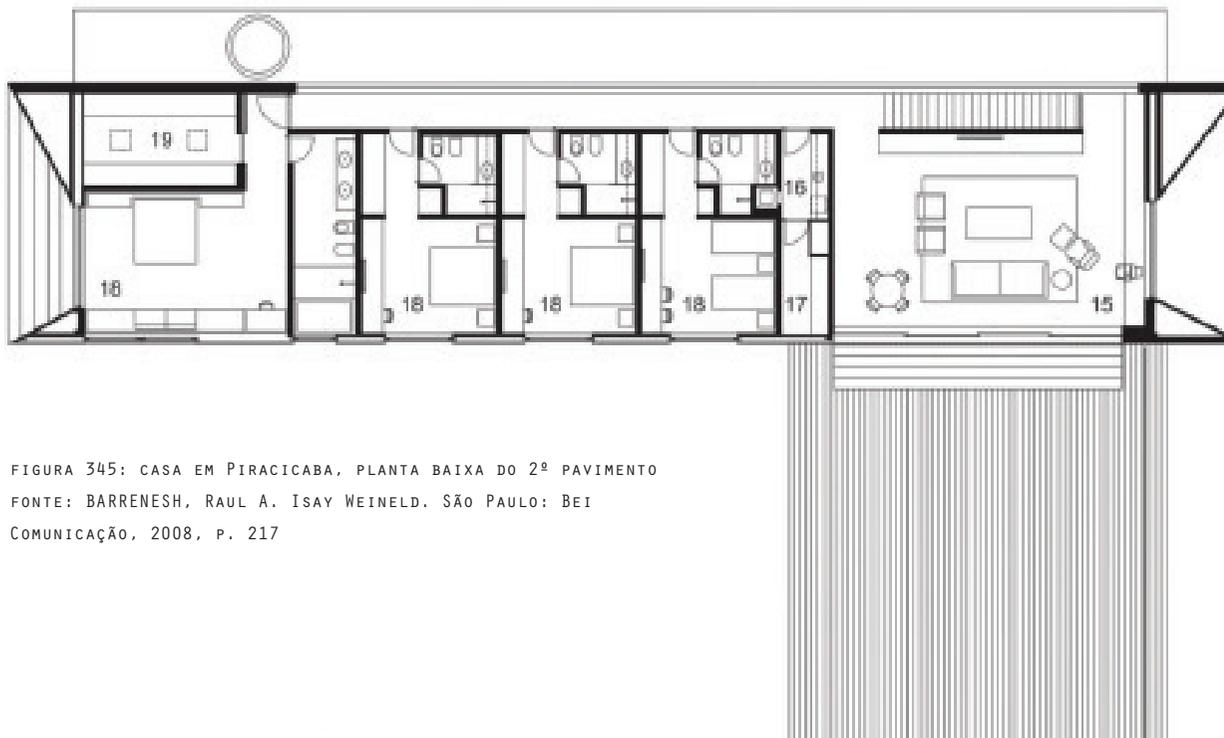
CASA EM PIRACICABA, PLANTA BAIXA DO 2º PAVIMENTO
